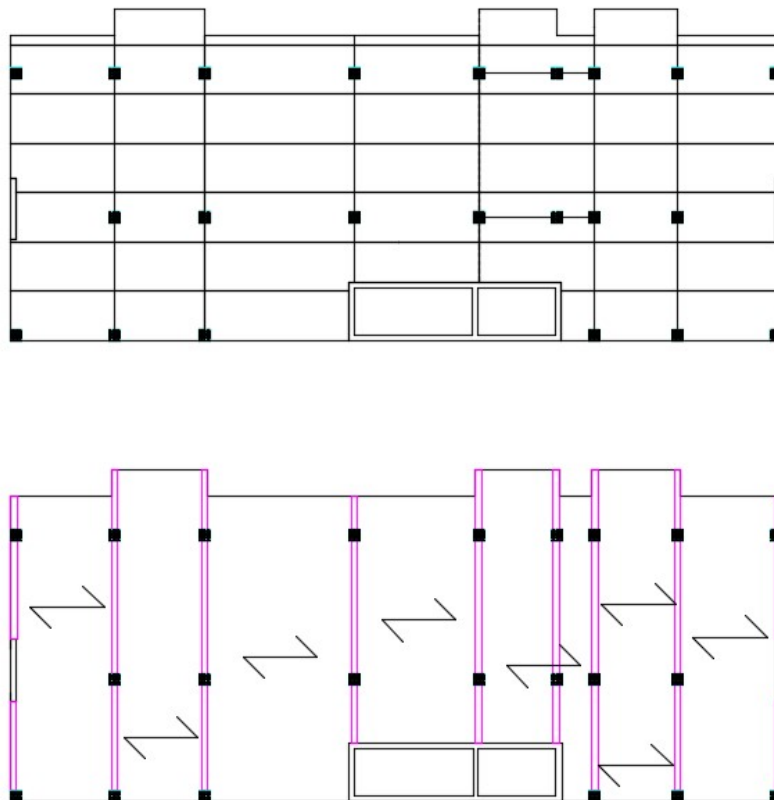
Distribución en planta de los pórticos y forjados a base de paneles CLT
